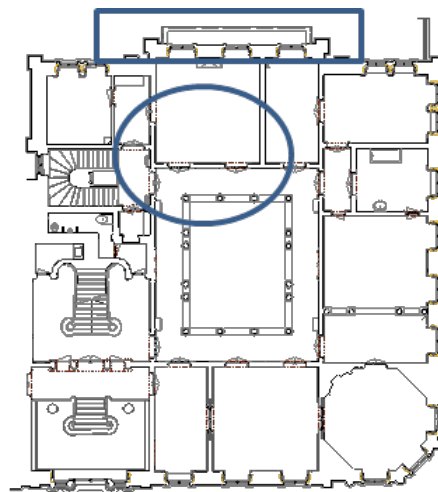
P R C - Planta Piso -1 em 2014.
